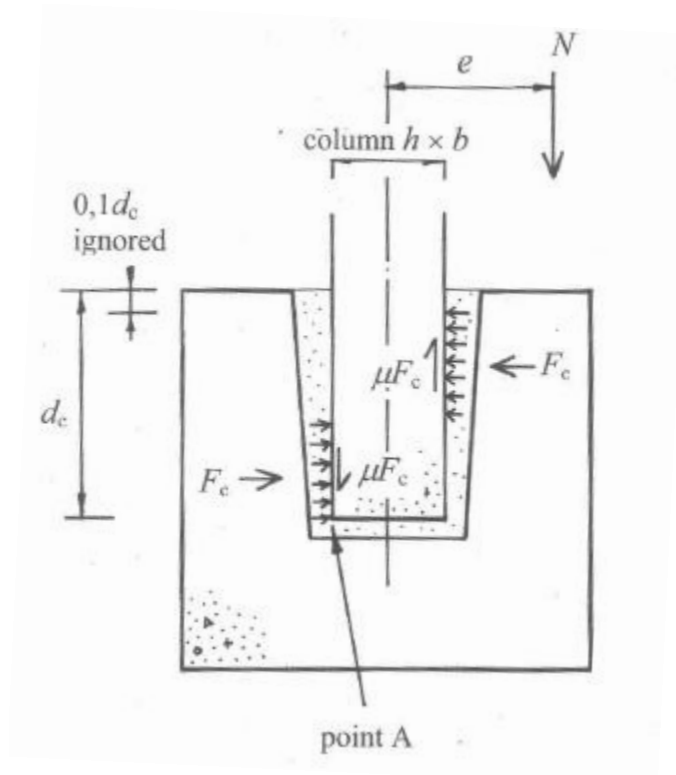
Dimensionamento della lunghezza di pilastro da inserire nel plinto prefabbricato. [FIB "Structural connections for precast concrete building"]
